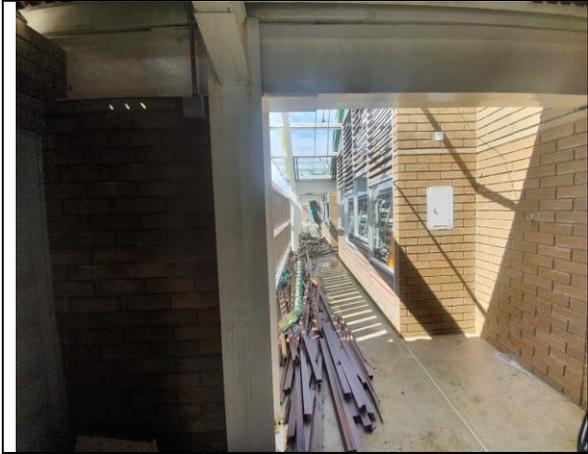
Estructura liviana y cubierta destruidas.
